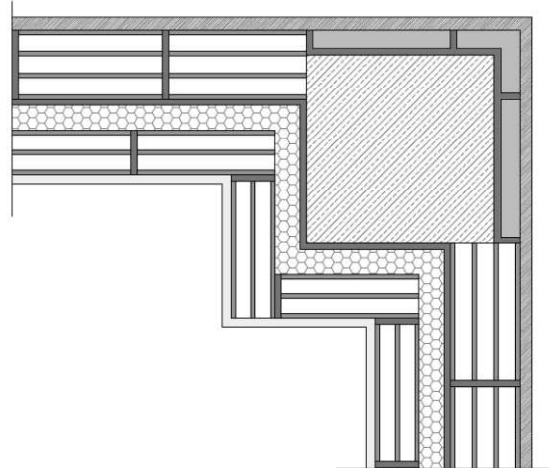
Pilar en esquina. Zona este. Estado rehabilitado.
